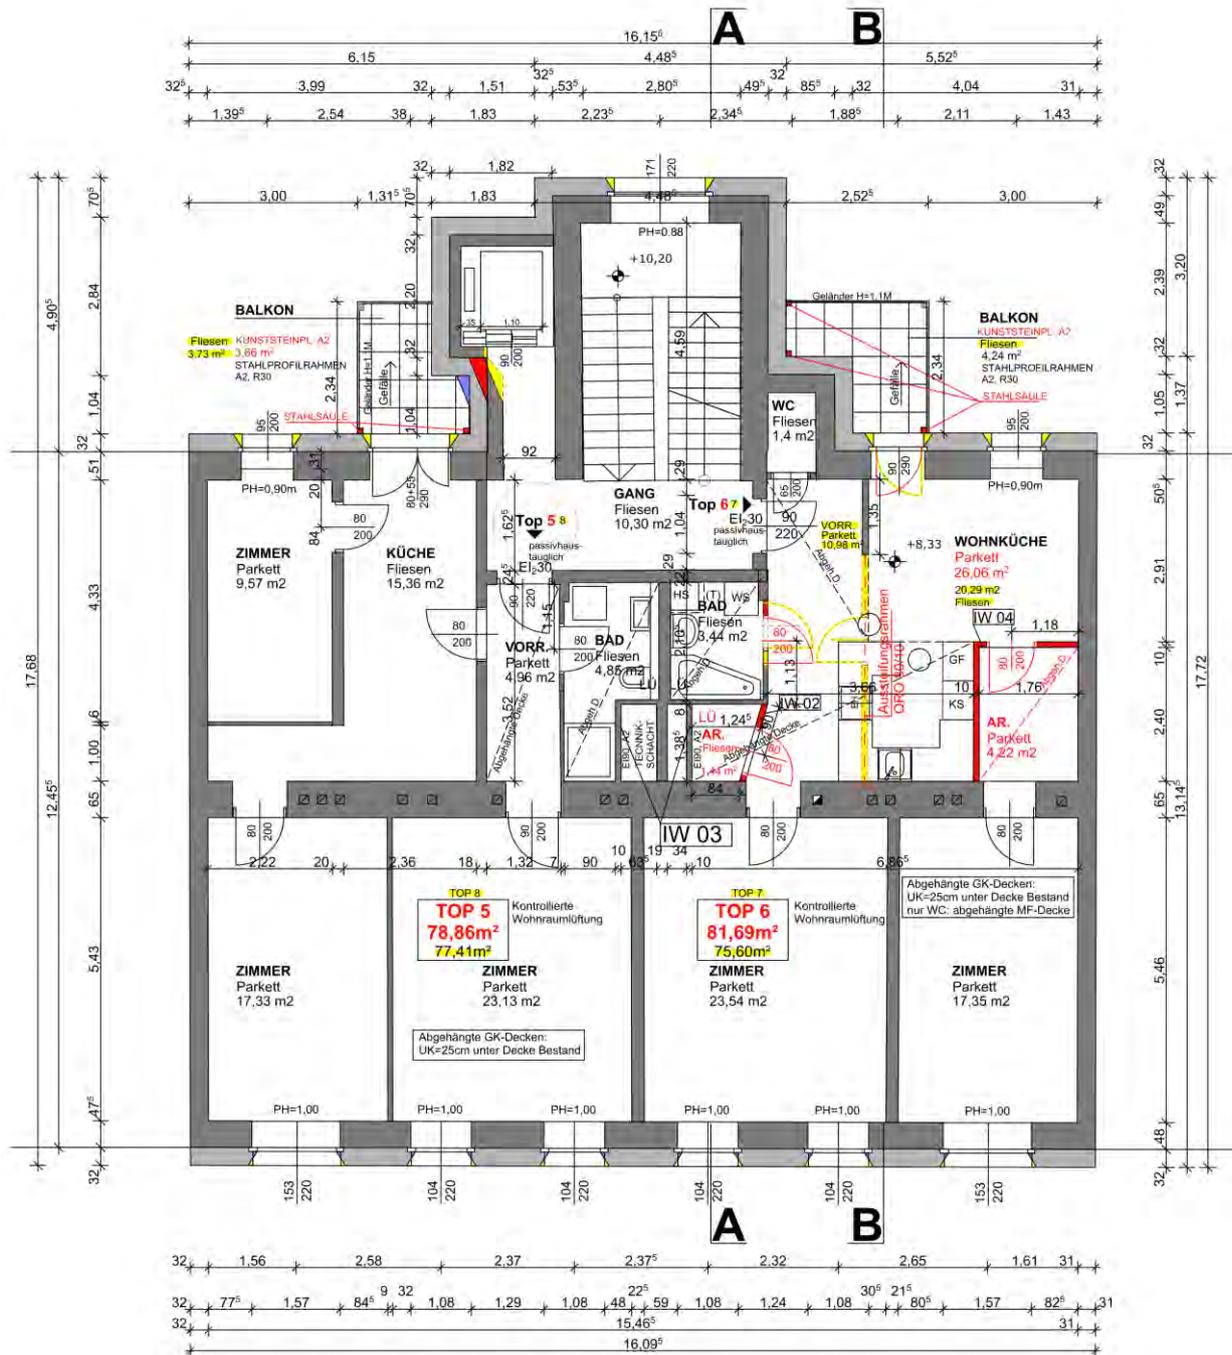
Grundriss 2.Obergeschoss [Quelle: Ageres Baumanagement]
